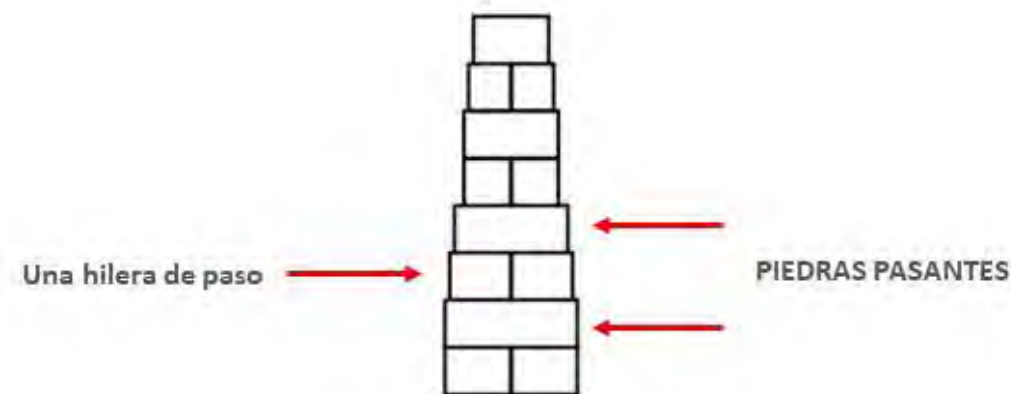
Vista de perfil del criterio usado para el arreglo 1
